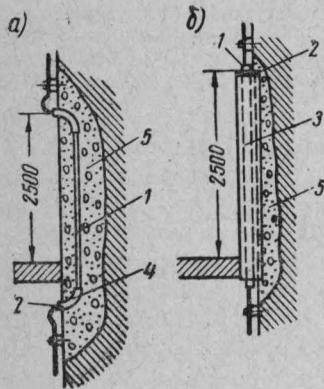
Проход провода через междуэтажное перекрытие в резиновой трубе (а) и стальной трубе (б):
